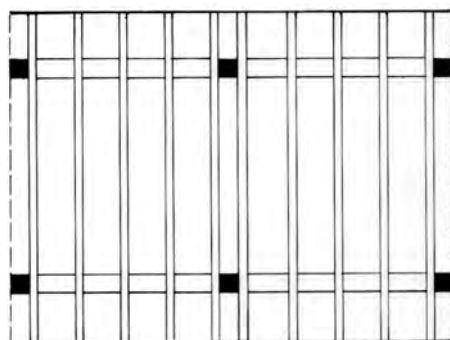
Planta baixa com os pilares e o sistema de suporte temporário. [FRAMPTON, 1979]:69c
